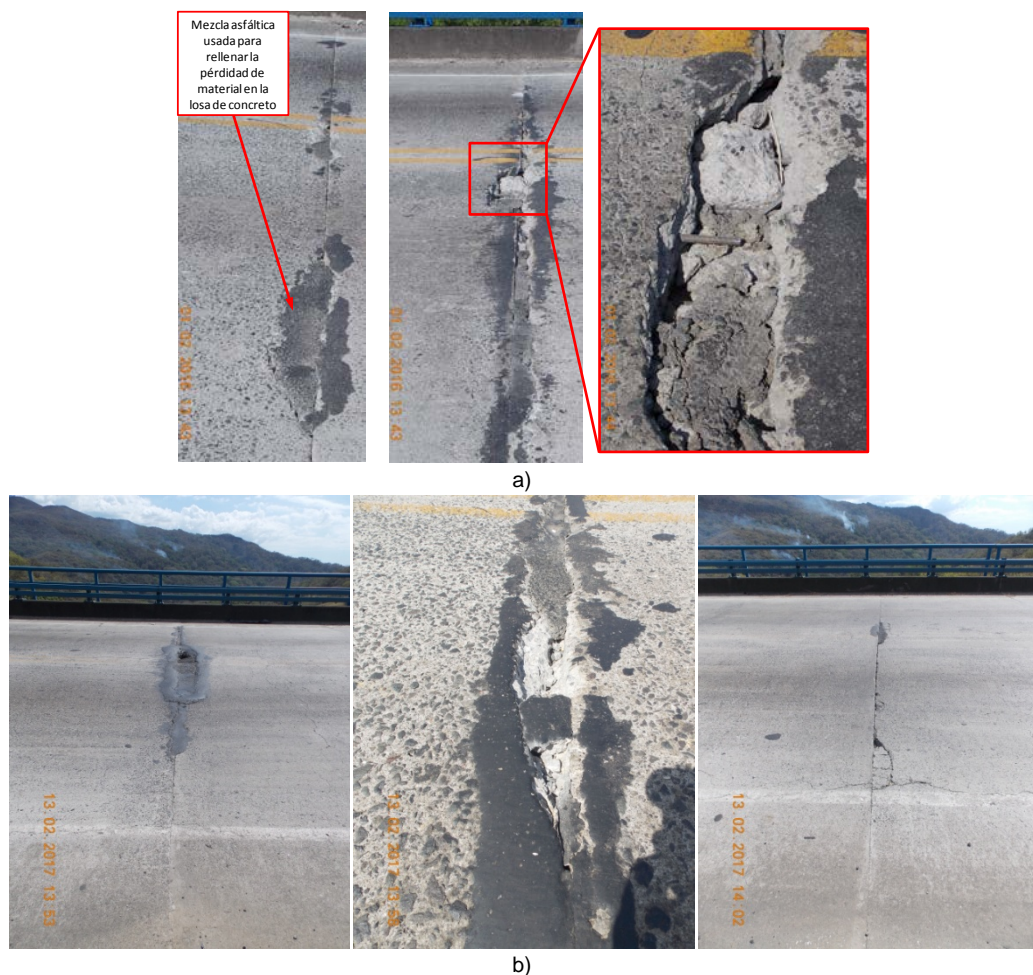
Puente sobre la quebrada Salitral. Deterioro de juntas de construcción a) año 2016; b) año 2017
